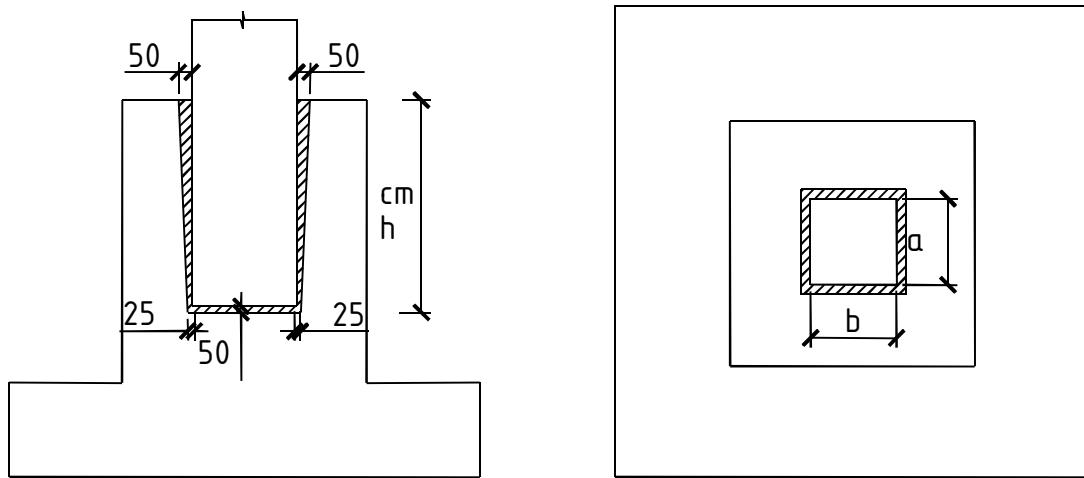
Схемастыка колонны и стакана фундамента, к определению объема заделки стыков колонн с фундаментами
